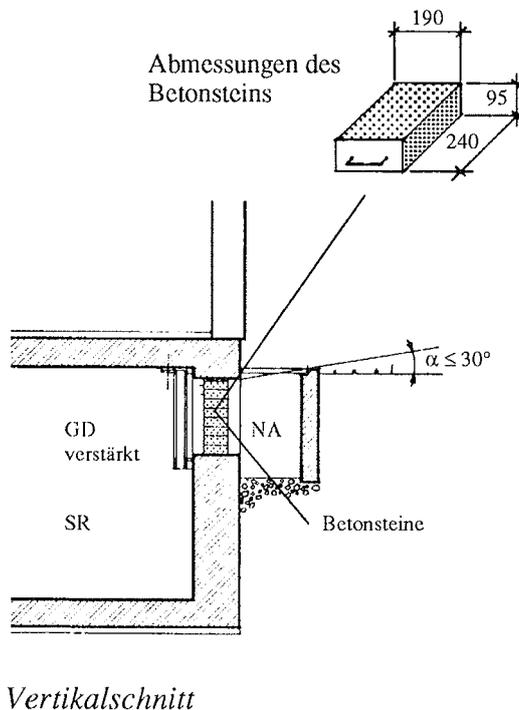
Detail zu Figur 3.4-4 für Deckel mit geringer Sturzhöhe
